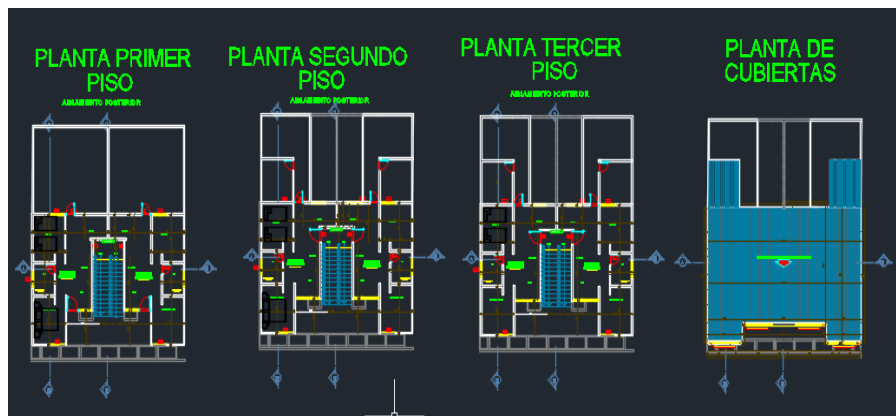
Diseño en planta edificio de viviendas para personas víctimas del conflicto armado. Fuente: Autor.
